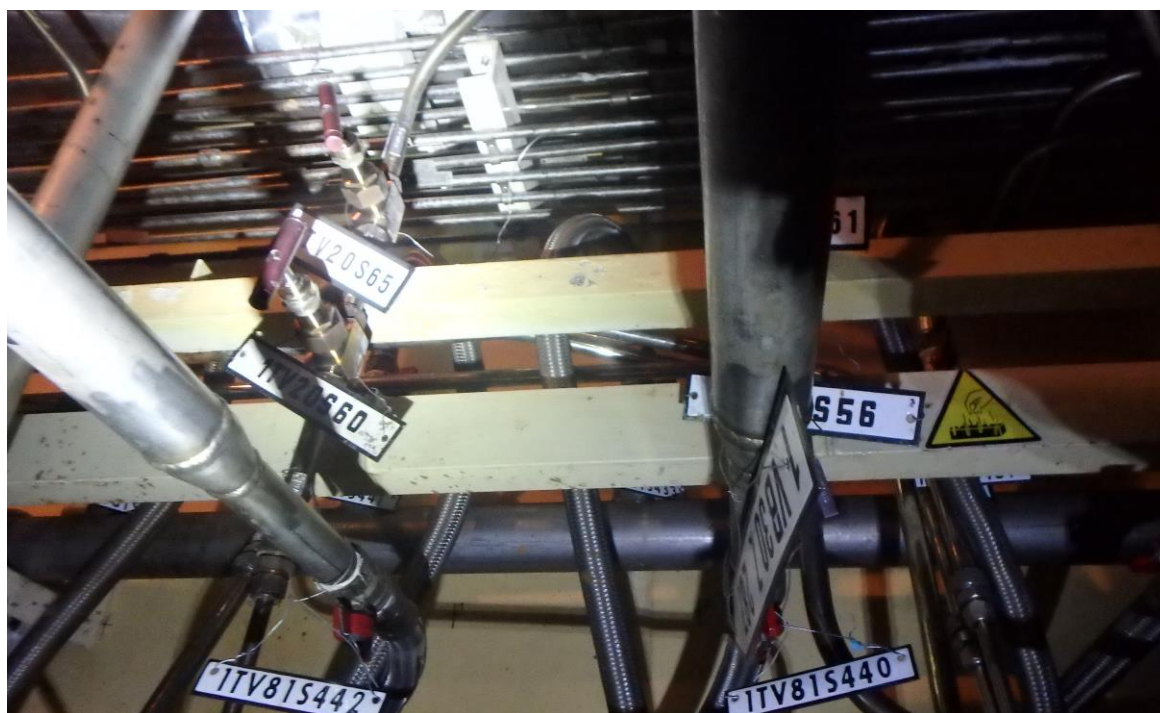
Pokračování společnou trasou odvodu přes tlakovou obálku, hraniční armatury RY11-14S06,07 [22].
